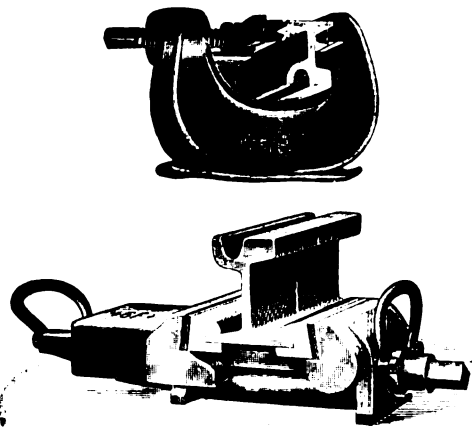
e 35. — Apparecchi per il montaggio del giunto Scheinig & Hoffmann.
